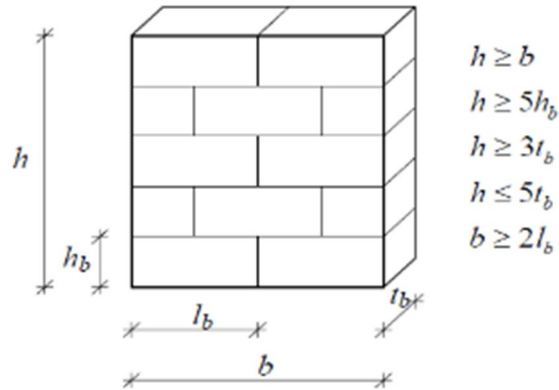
12 : Les dimensions du spécimen pour un essai de RILEM [22].
